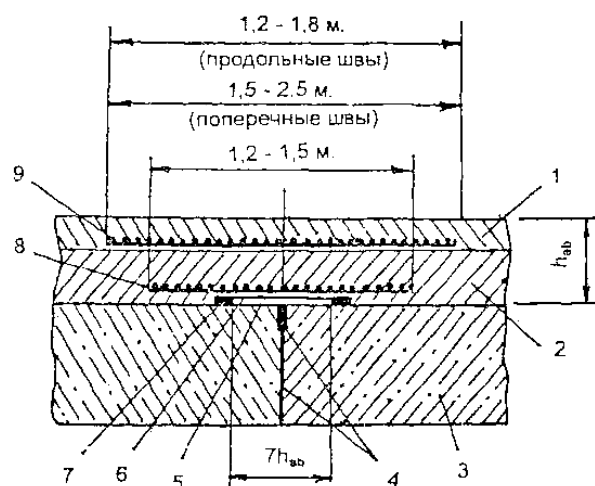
Ленточное армирование двухслойного асфальтобетонного слоя усиления: 1 и 2 - верхний и нижний слои асфальтобетона; 3 - существующее жесткое покрытие; 4 - деформационный шов (или трещина); 5 - побелка известью; 6 - разделительная прослойка; 7 - битум; 8 - сетки армирования соответственно нижнего и верхнего слоев
